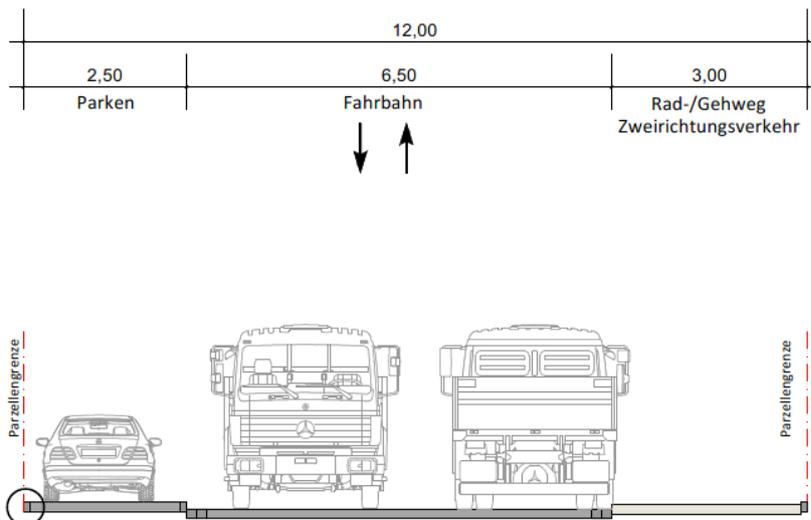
Stichstraße im Bebauungsplan 85 S, Gemeinde Aldenhoven
